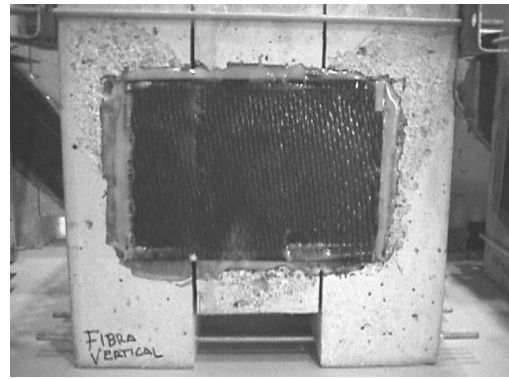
Ensayo tipo TRI-Unión V con las galgas adheridas sobre las fibras longitudinales.
